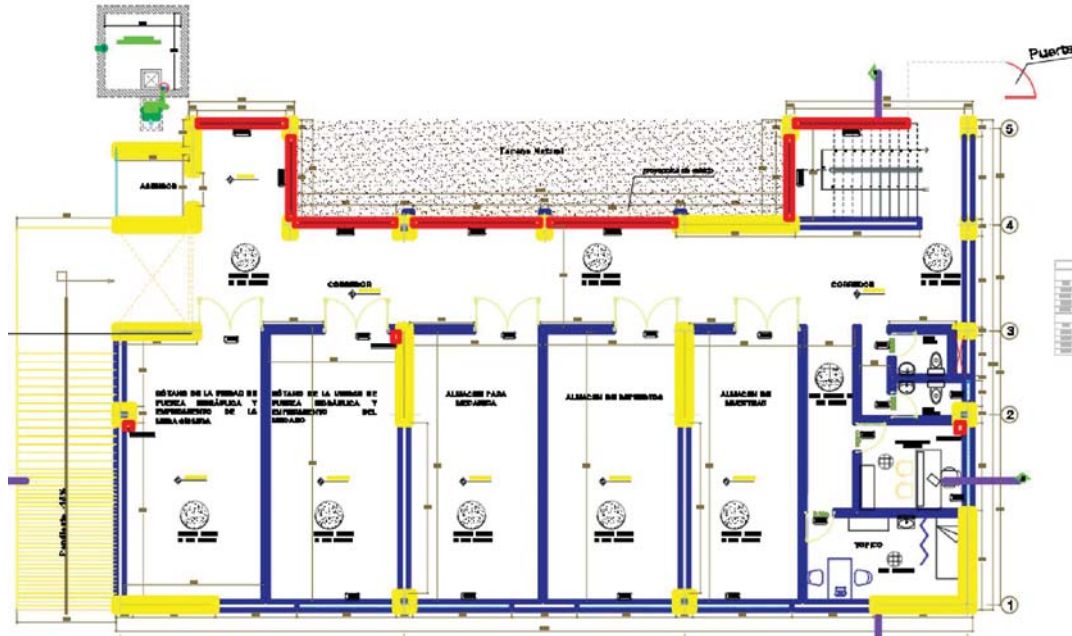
PLANTA DE DISTRIBUCIÓN SEMISÓTANO
